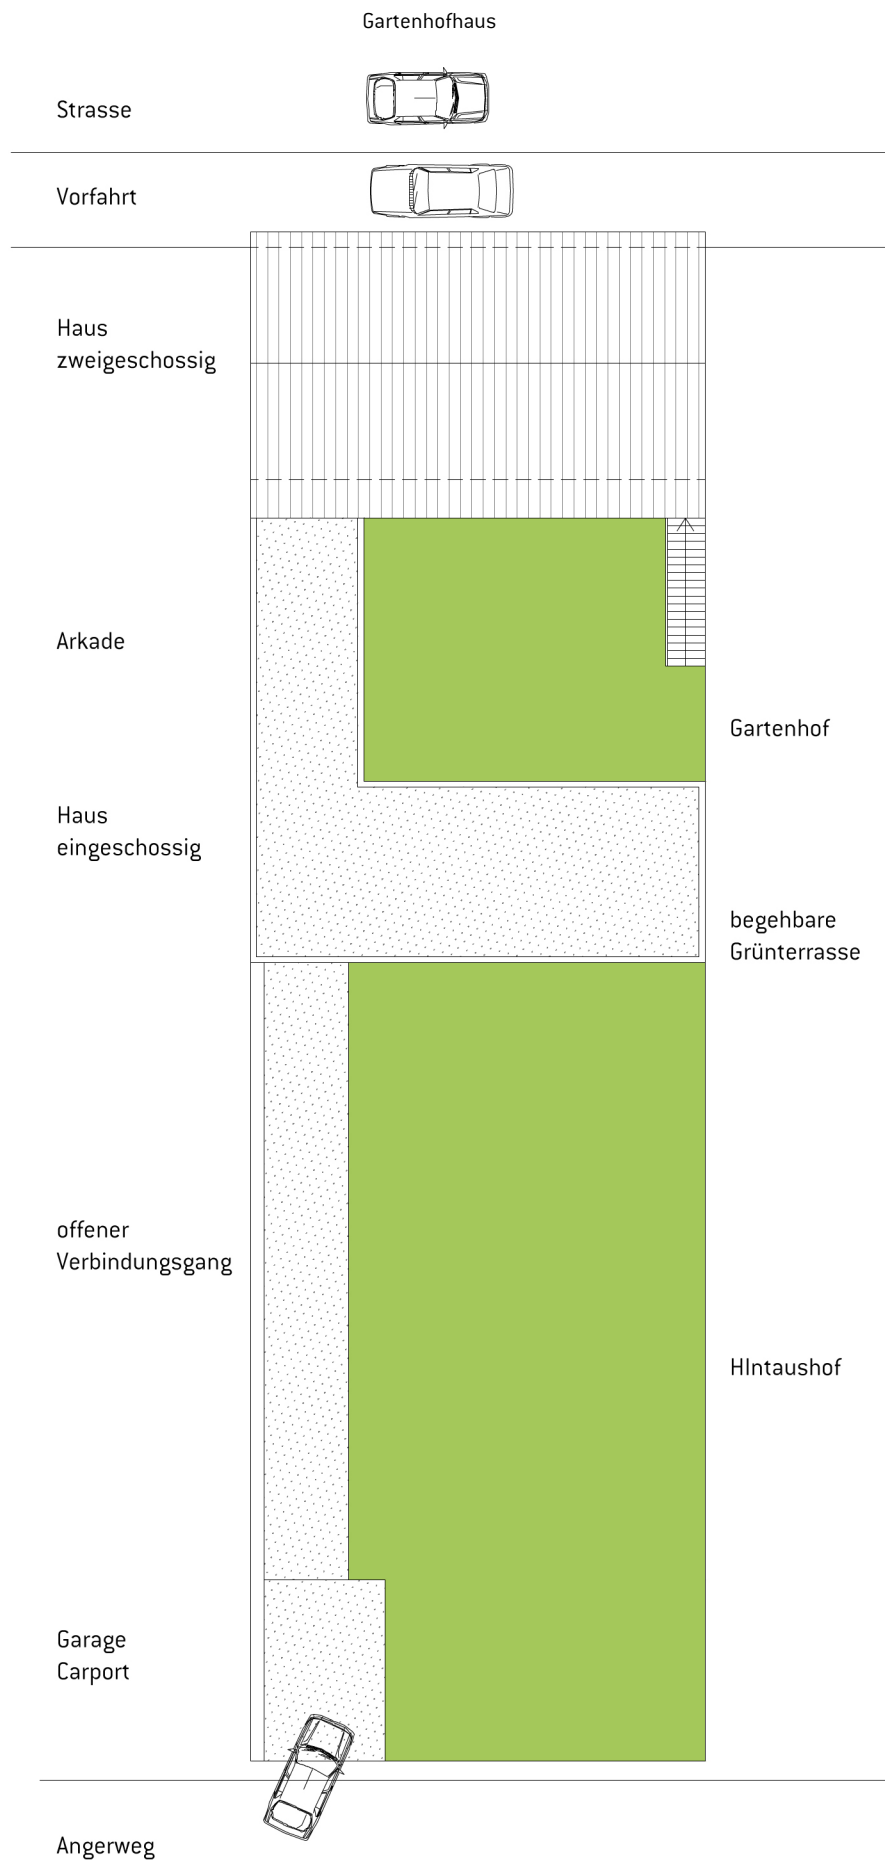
Schemaplan (M 1:250) des Prototyps eines Gartenhofhauses in geschlossener Bauweise.
